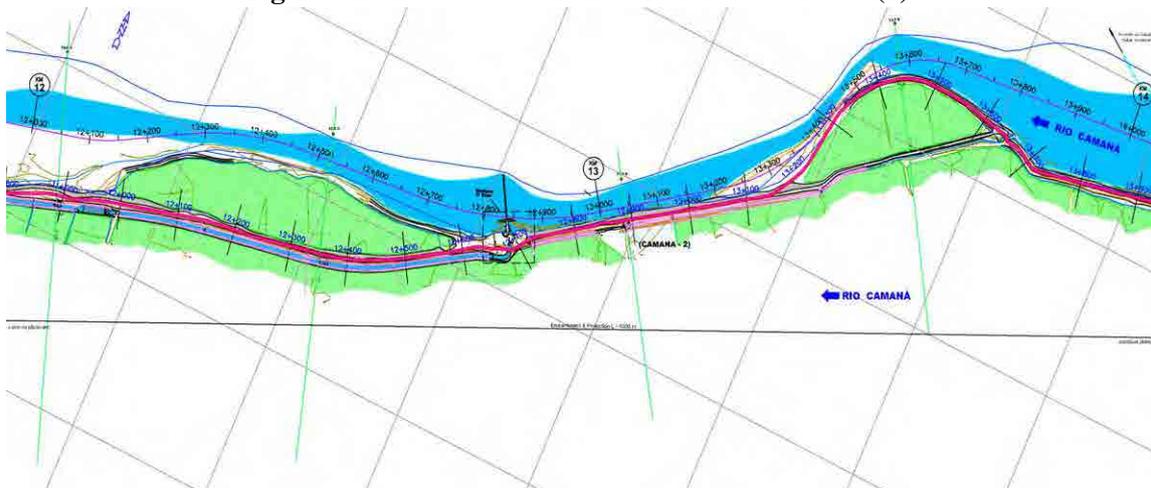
Planta de instalaciones Caman-3 (3)
